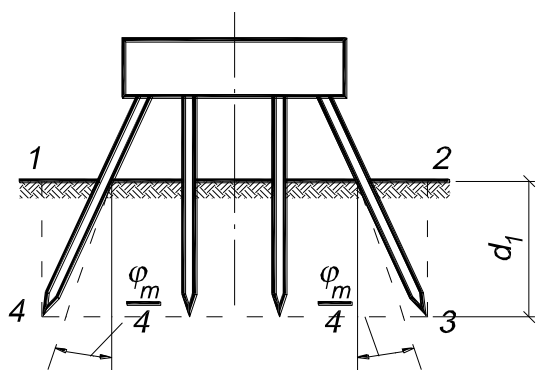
Умовний пальовий фундамент з ростверком, заглибленим в ґрунті при куті нахилу паль менше, ніж  $\varphi_m / 4$
